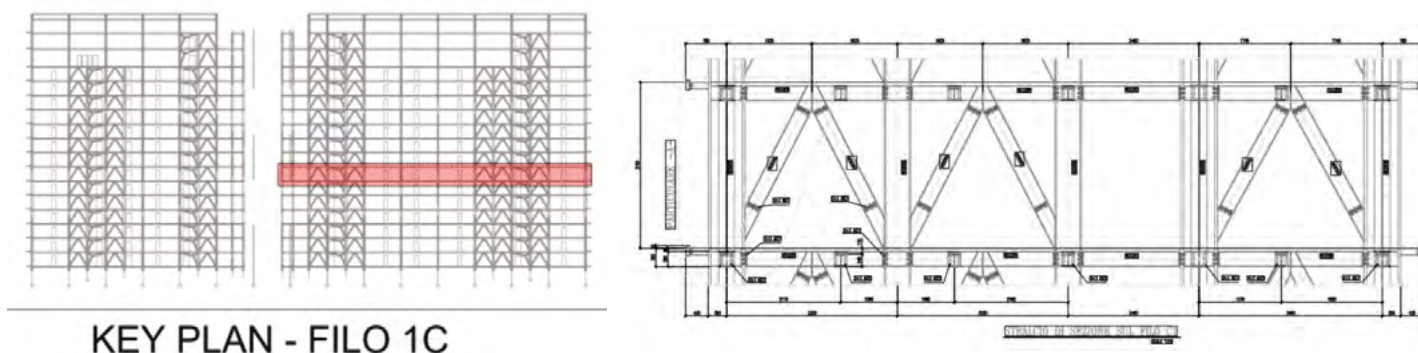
Sezione trasversale dell'auditorium e dettaglio
